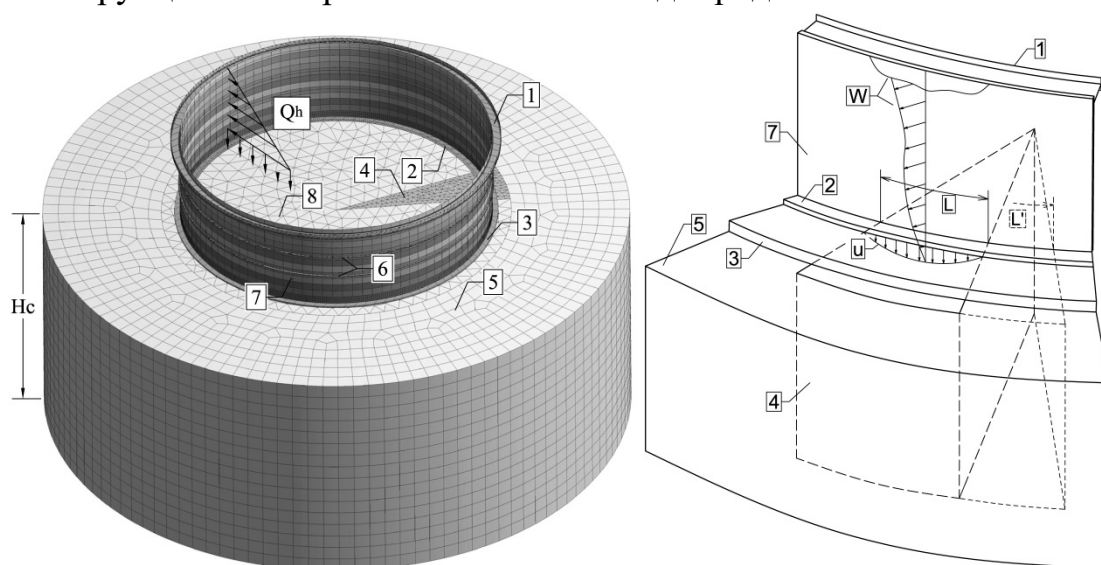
Расчетная схема (а, б): 1 – ветровое кольцо; 2 – окрайка; 3 – железобетонный кольцевой фундамент; 4 – сильносжимаемый грунт зоны неоднородности; 5 – грунтовое основание с проектными характеристиками; 6 – усиливающие кольца жесткости на V и VIII поясах стенки; 7 – стенка РВСПК-50000; 8 – центральная часть днища; Q_h – гидростатическая нагрузка; R – радиус резервуара; L – длина сектора зоны неоднородности (по наружному контуру днища); H_c – сжимаемая толщина; W – радиальные перемещения стенки; u – осадка наружного контура днища
